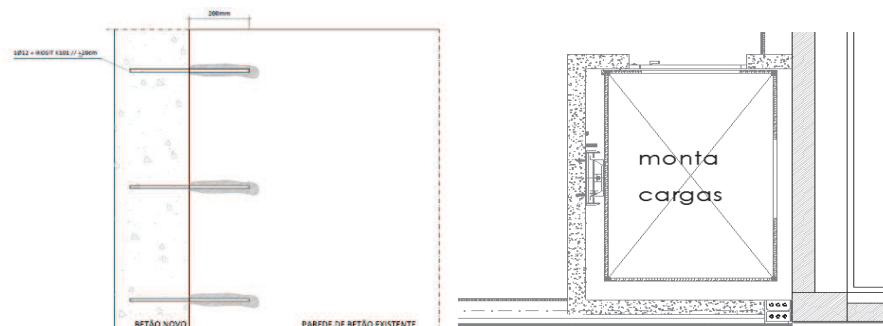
Pormenor construtivo de amarração da nova estrutura à já existente.
